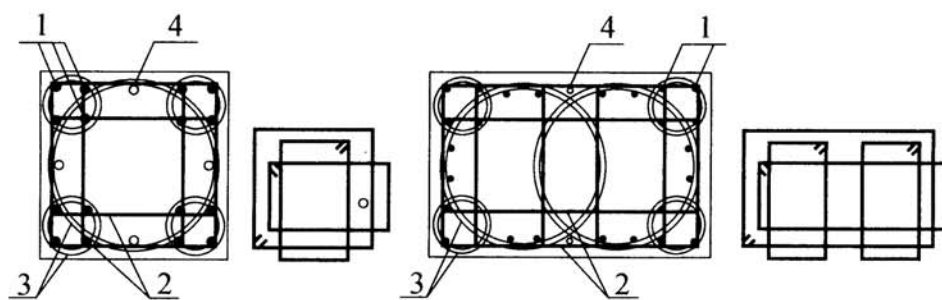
贯穿节点区柱纵向钢筋及箍筋构造
